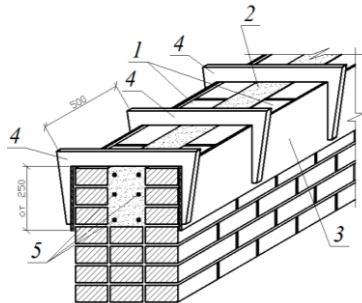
Принципова схема підсилення багатощарової цегляної кладки використанням фіксаторів: 1 – існуюча внутрішня і зовнішня поверхні цегляної кладки; 2 – бетонна суміш; 3 – опалубні поверхні; 4 – фіксатори опалубної системи; 5 – внутрішні арматурні каркаси (або окремі стрижні).
